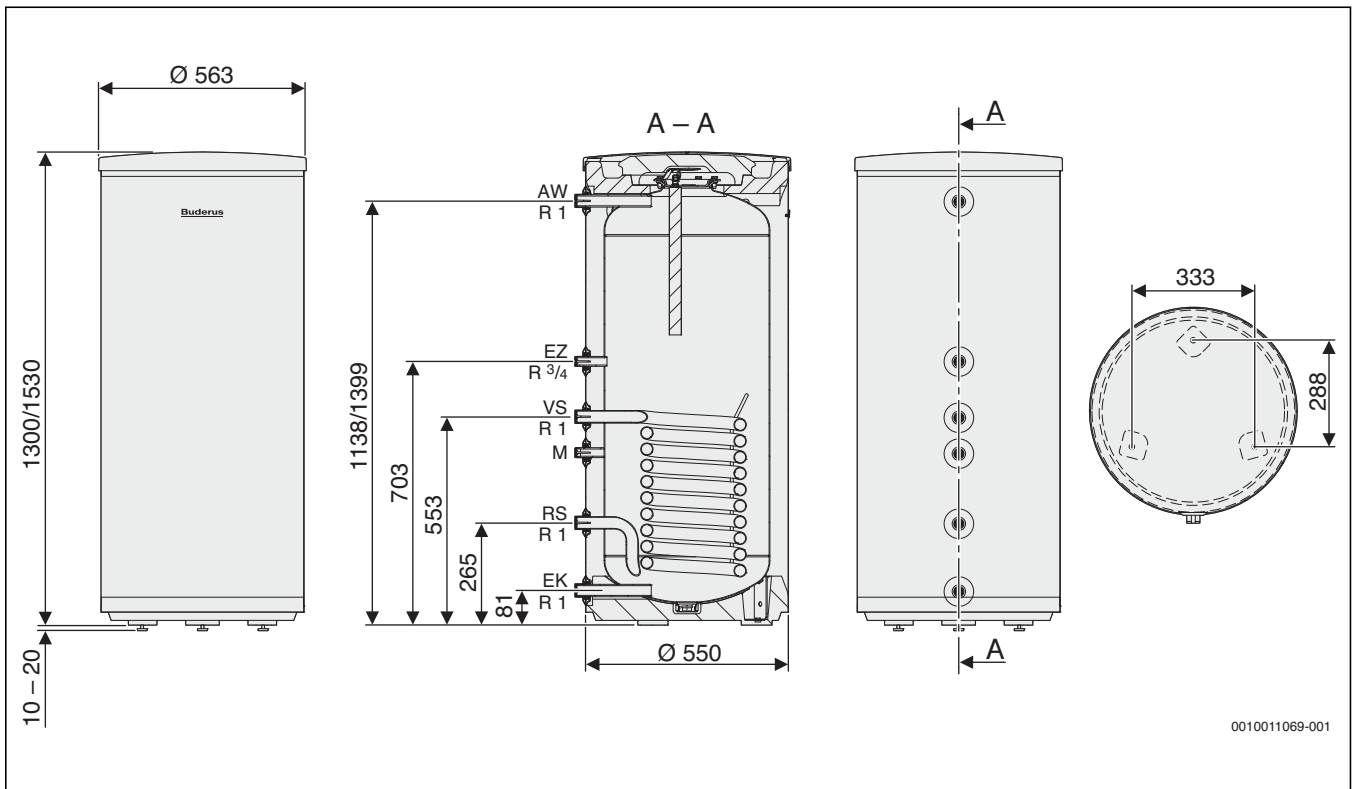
Abmessungen und Anschlüsse Logalux SU160/200.5 (Maße in mm)
